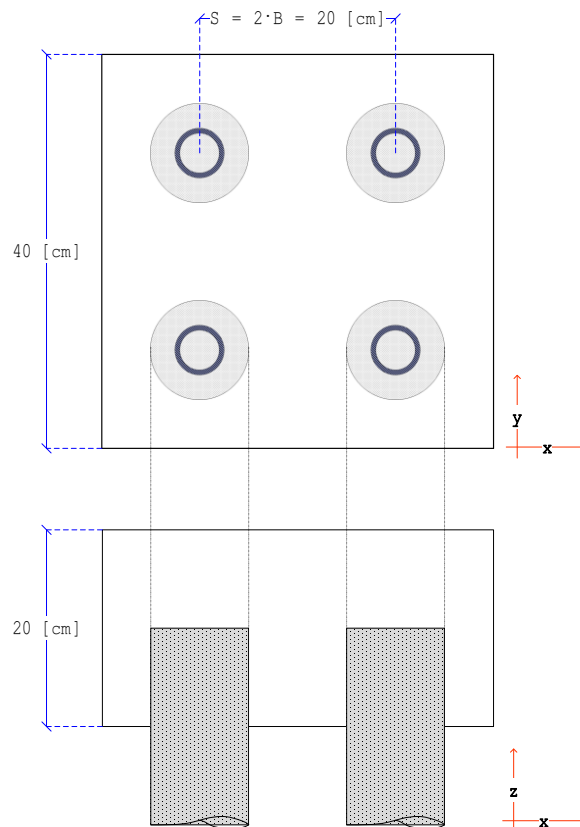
Arreglo del grupo 4 micropilotes en la plataforma de hormigón, vista en planta y lateral
